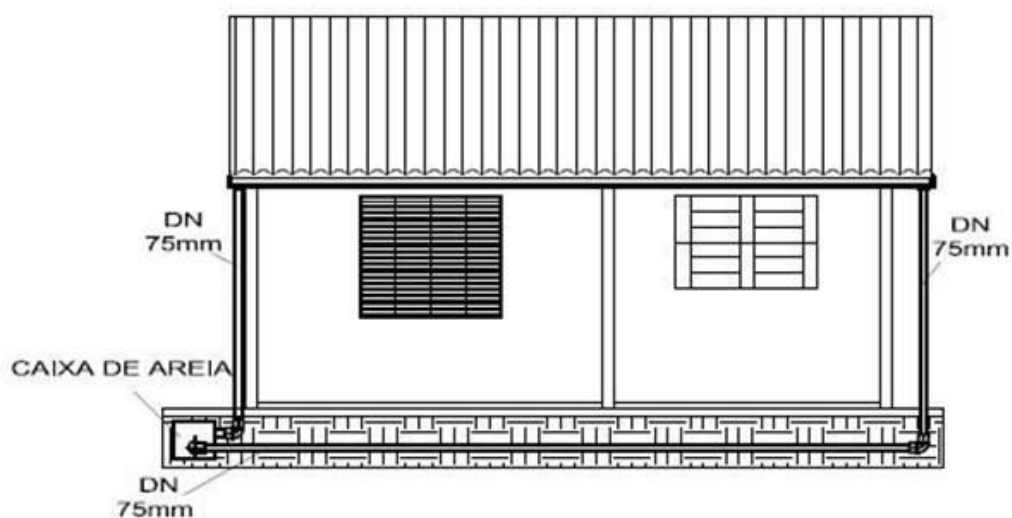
Detalhe condutores horizontais, verticais de caixas de areia.
